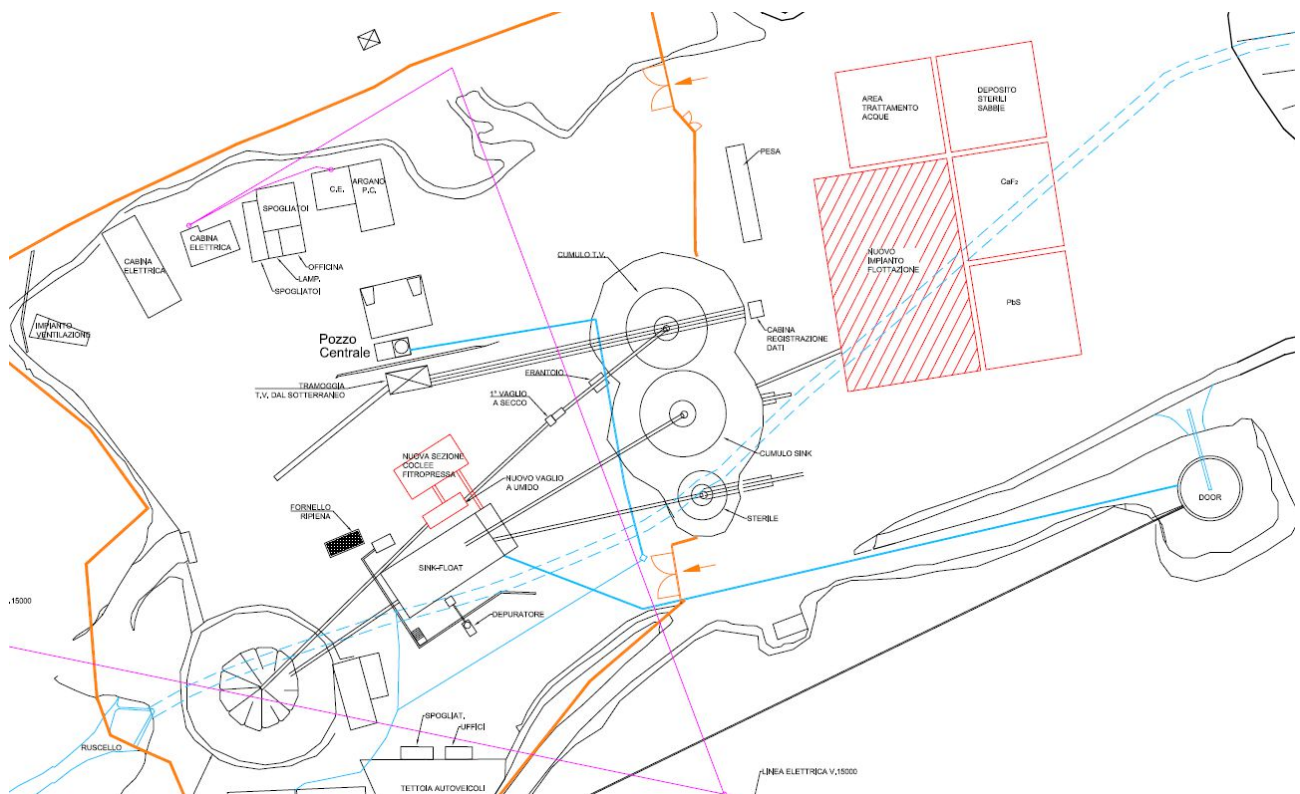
Planimetria schematica delle nuove strutture in progetto (in rosso, sulla destra).
